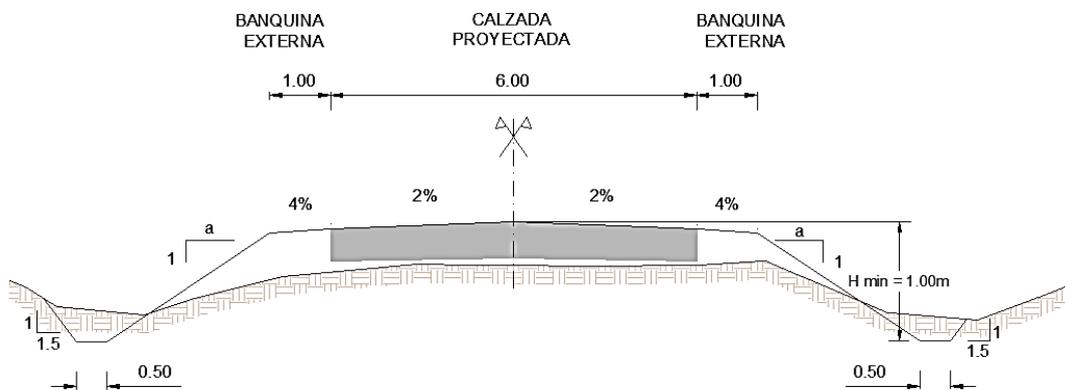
Perfil tipo de obra básica entre PR 0+000 – PR 1+925
